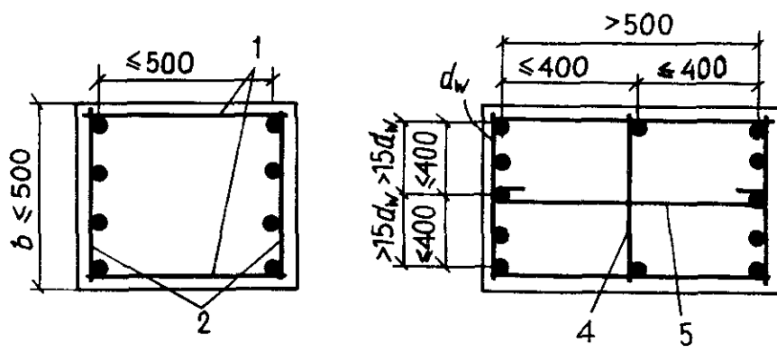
1 – соединительные стержни; 2 – плоские сварные каркасы;
